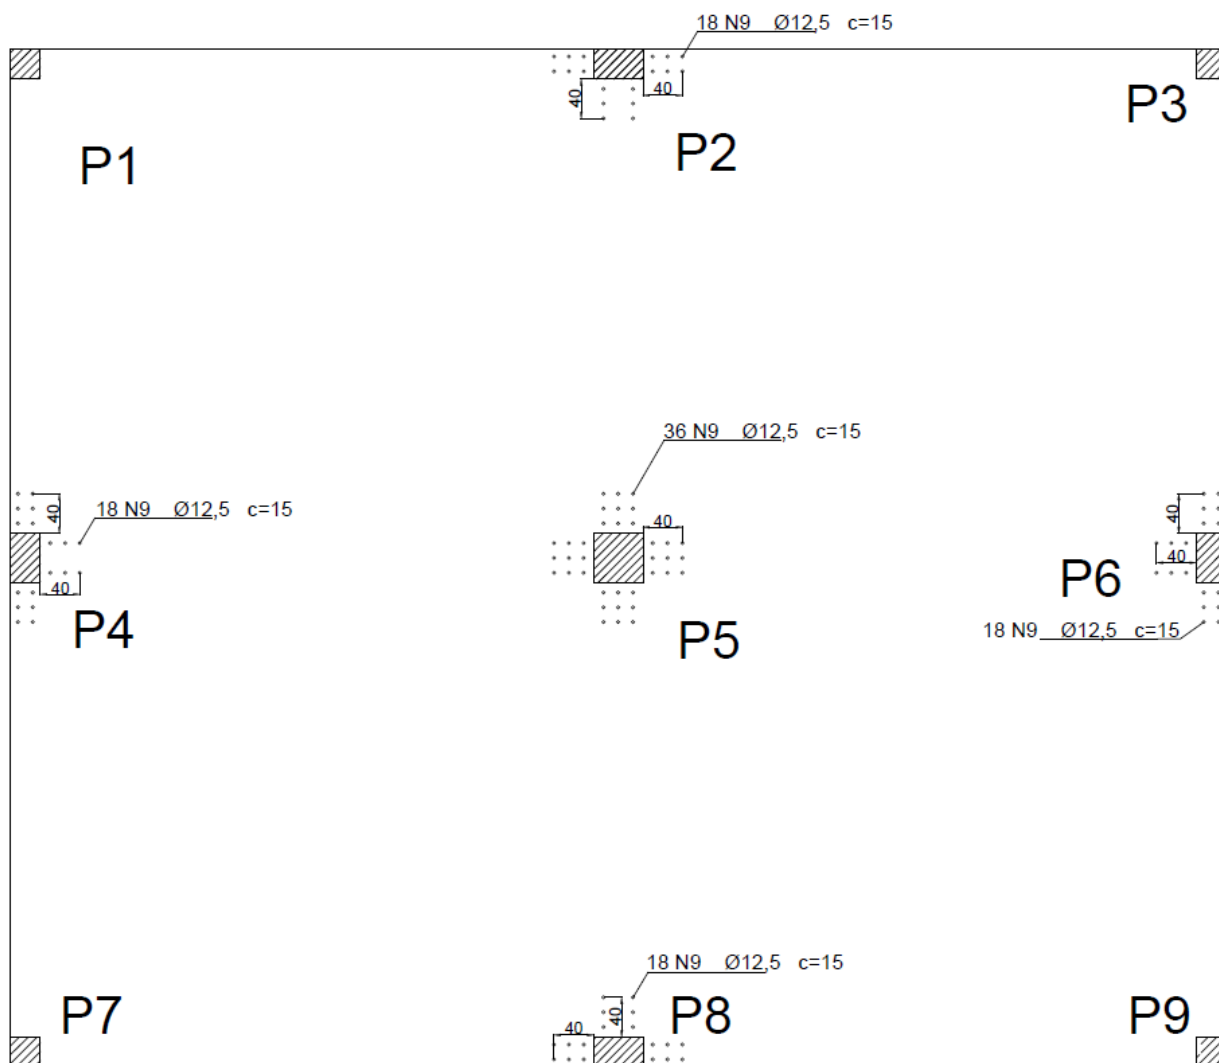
Laje com a armadura de punçoamento NBR 6118/2014
